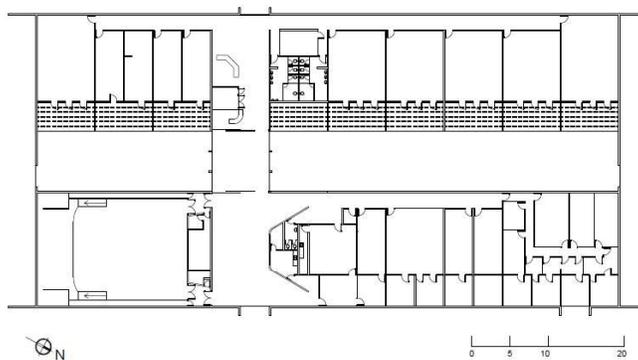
FE5, planta baixa. Fonte: Prefeitura da *campus* (adaptado por Christine Lucas).
